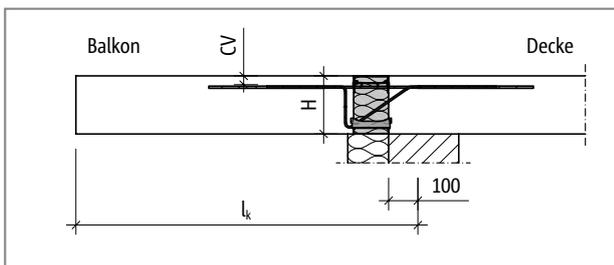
Schöck Isokorb® Typ KXT: Statisches System
